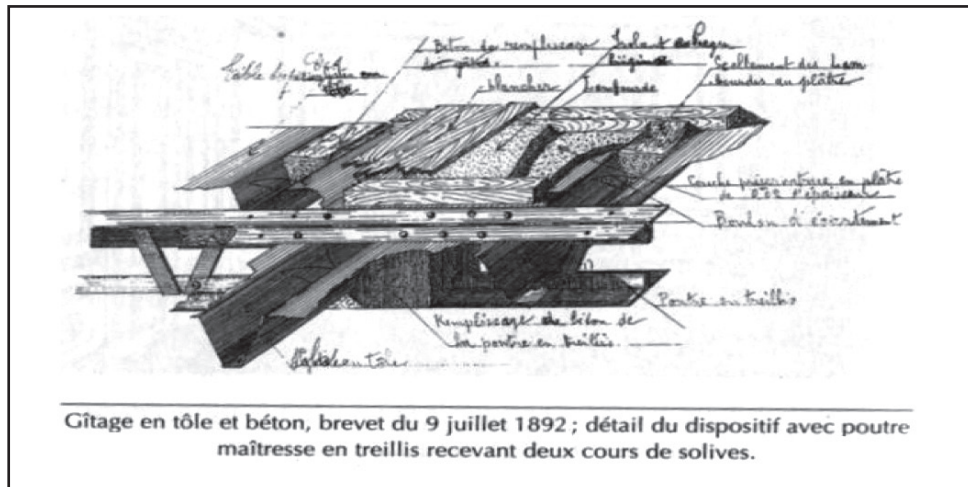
Interacción entre láminas de acero y concreto: detalle de dispositivo con viga maestra estilo armadura. Extracto de la patente del 9 de julio de 1892.
